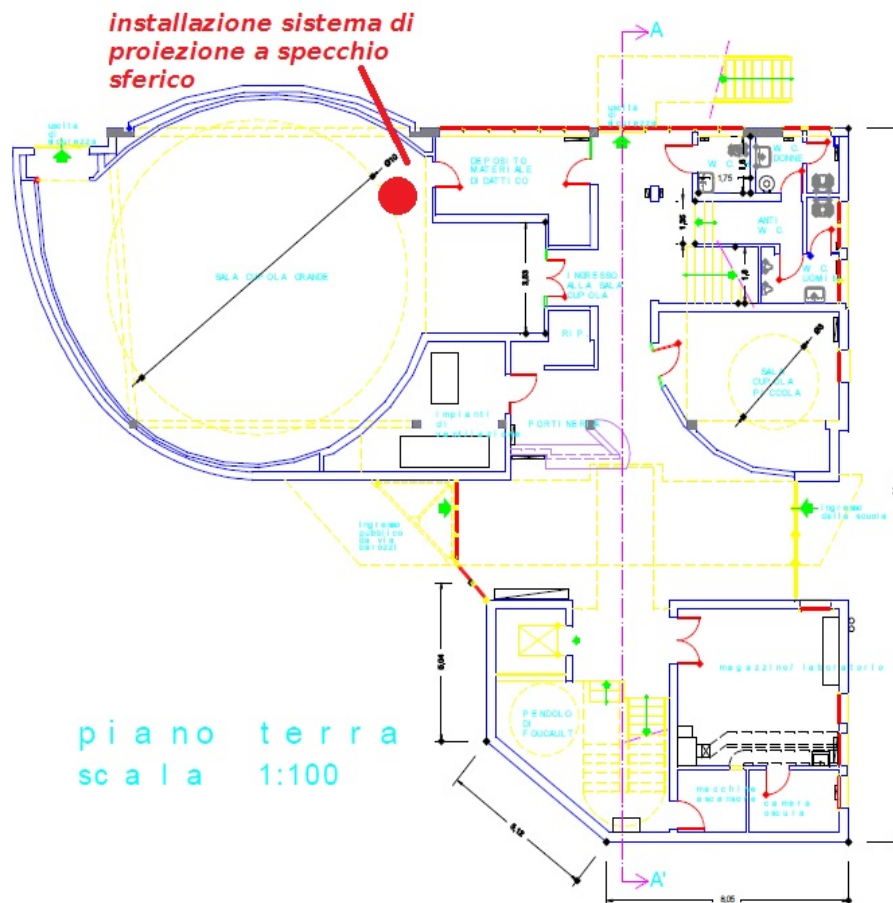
Pianta del piano terra dell'edificio ospitante il Planetario: in rosso è indicata la posizione stabilita per l'installazione del sistema di proiezione.
